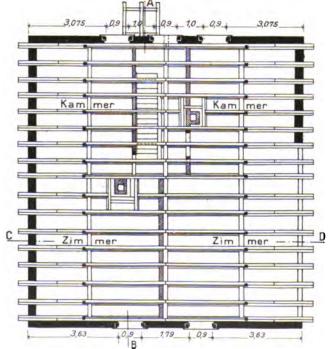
Werkplan des Erdgeschosses. M. 1:150.
